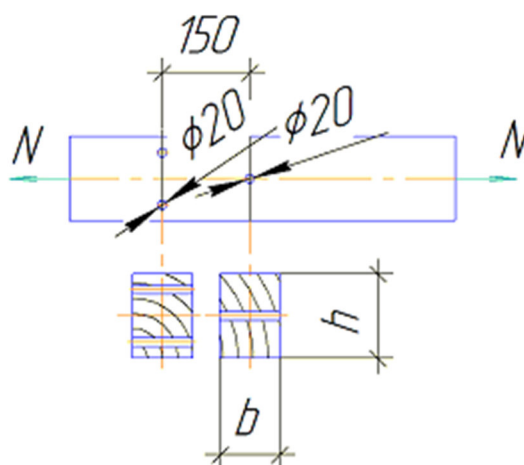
Расчётная схема к примеру расчёта на растяжение деревянного элемента
